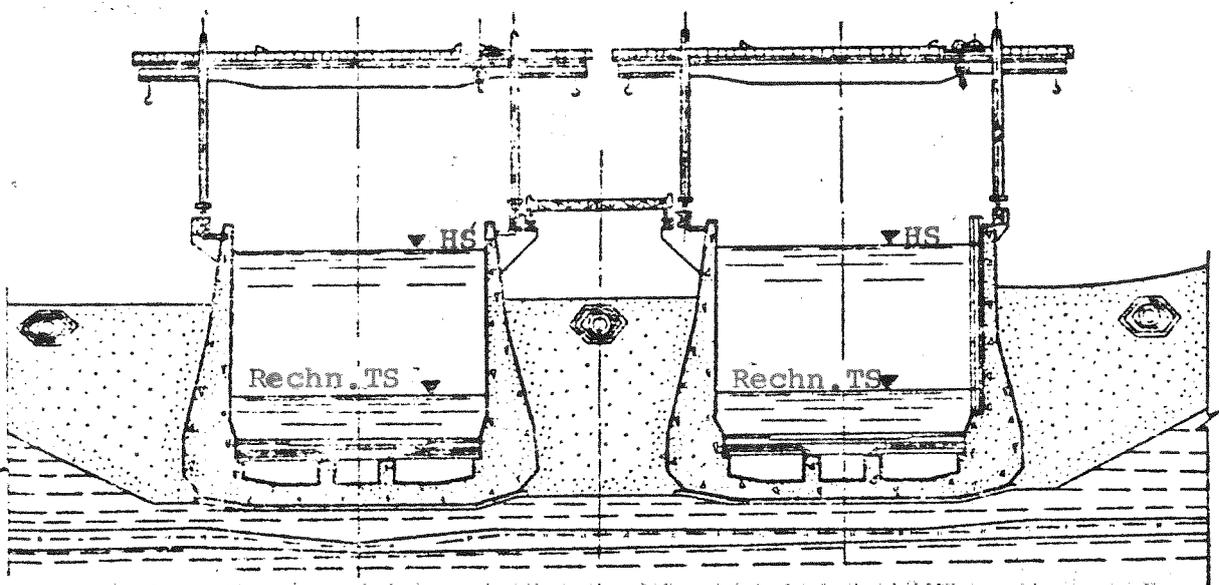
Querschnitt durch die Kammern mit den Bockkränen
